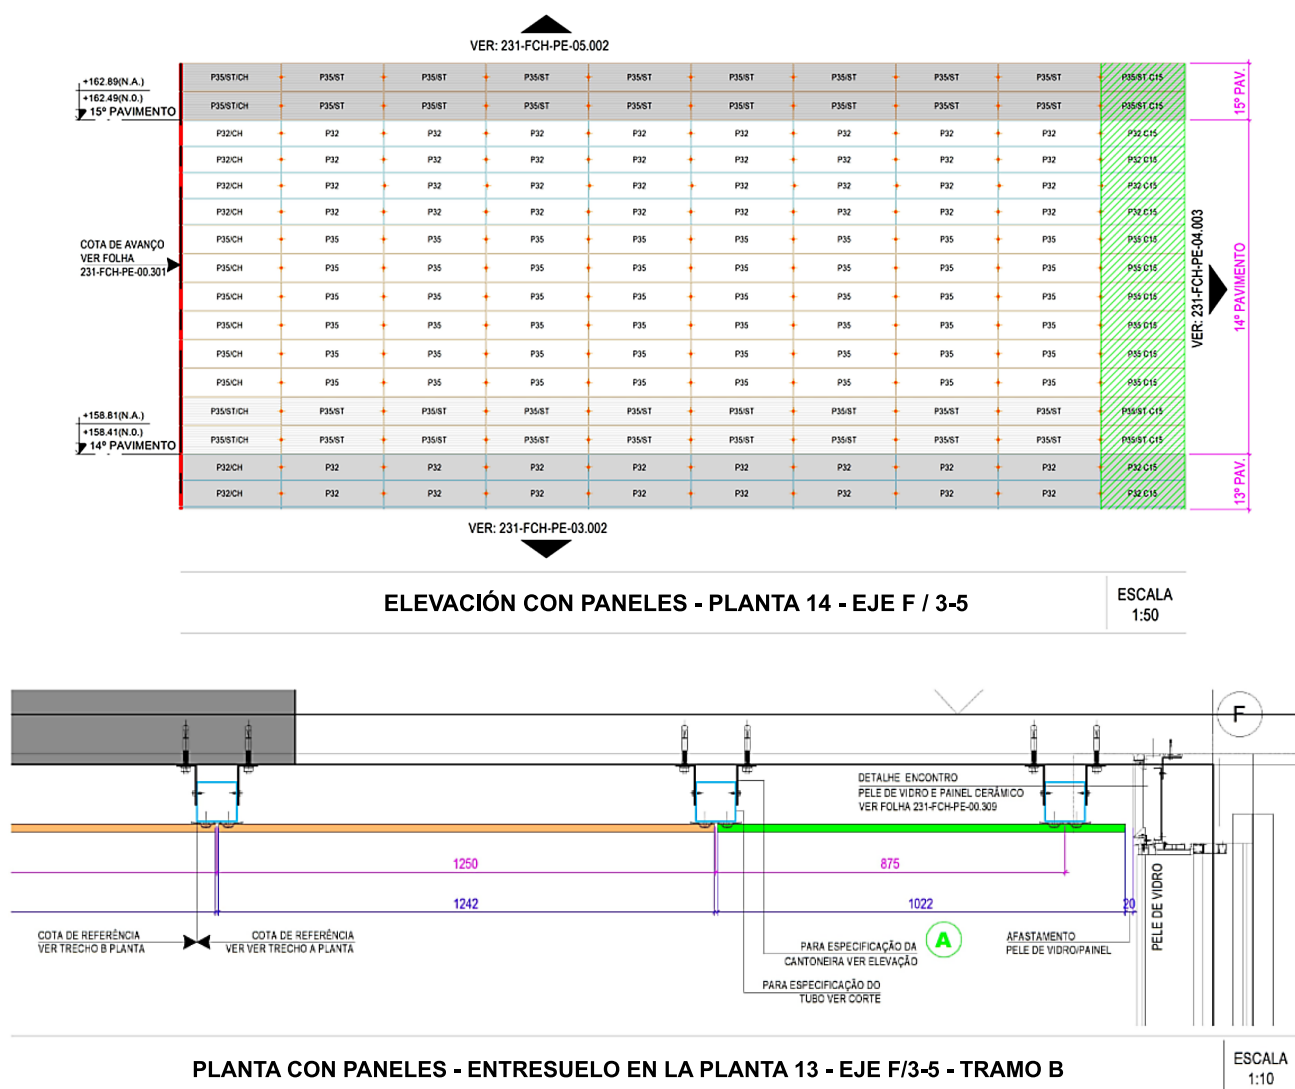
Elevación y planta de una fachada ventilada con paneles extrudidos. Los paneles "A" son los de ajuste debido a la falta de alineación de la estructura.
